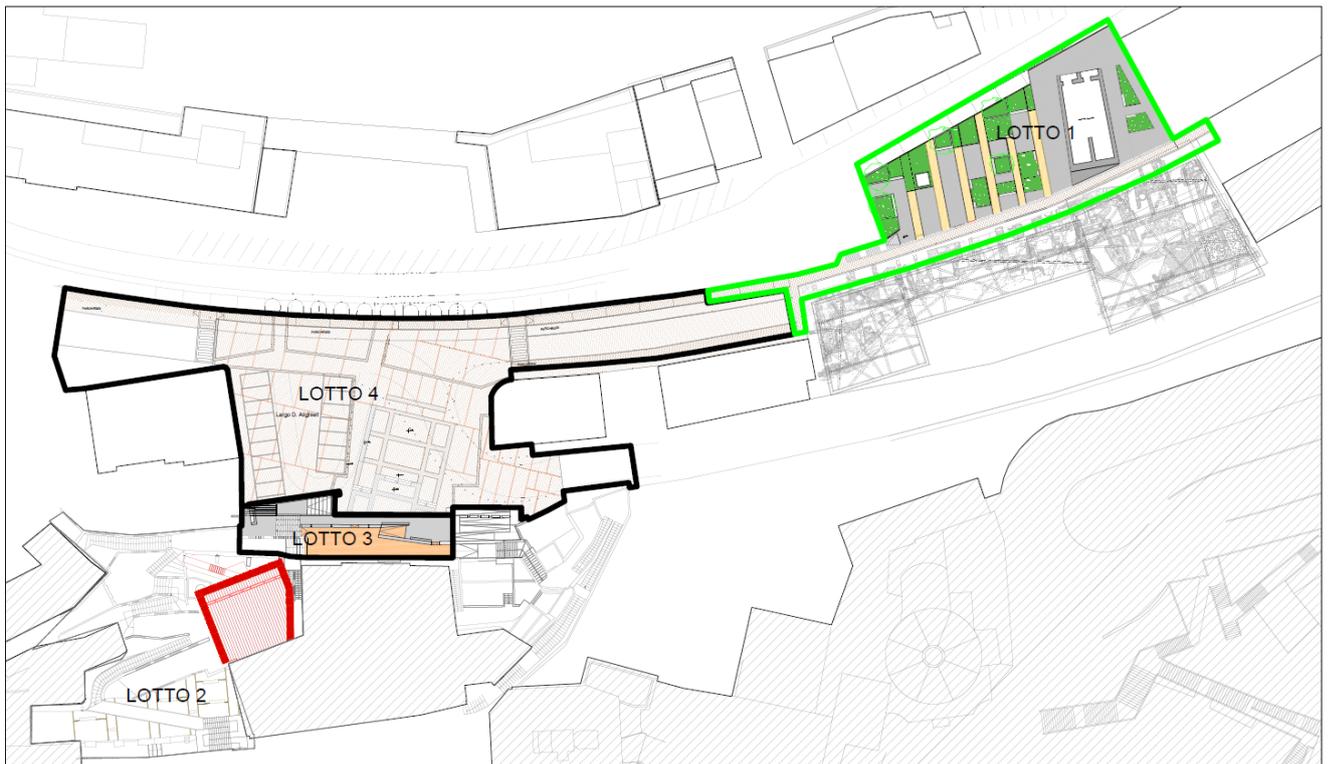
planimetria generale degli interventi di progetto con la divisione in lotti
